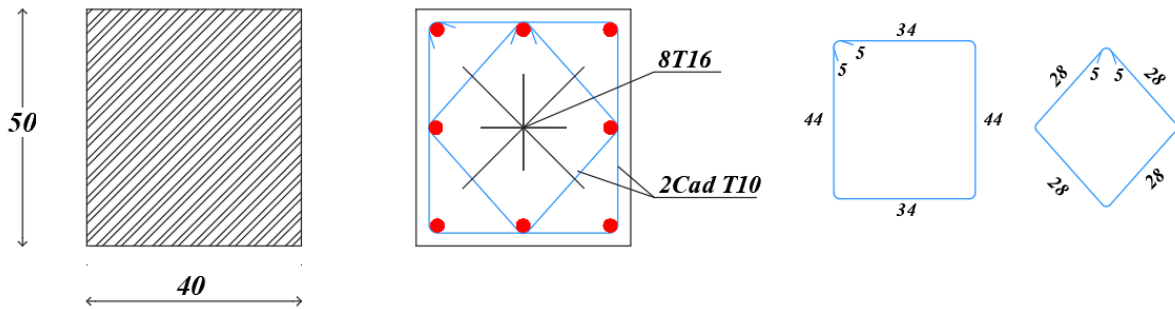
Schéma de ferrailage des poteaux (50x40)
